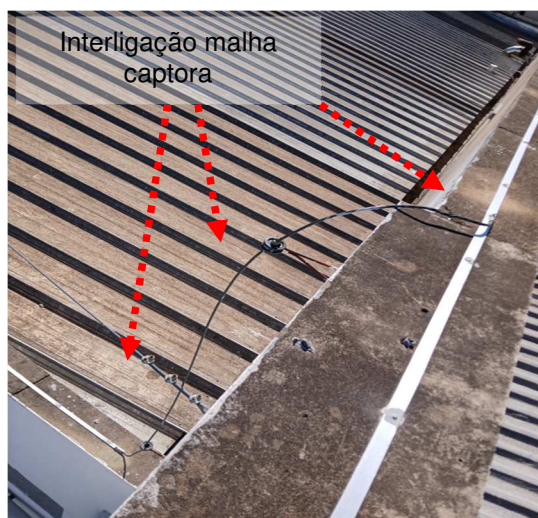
e 95: Malha captora construída em perfil de alumio secção #70mm².
